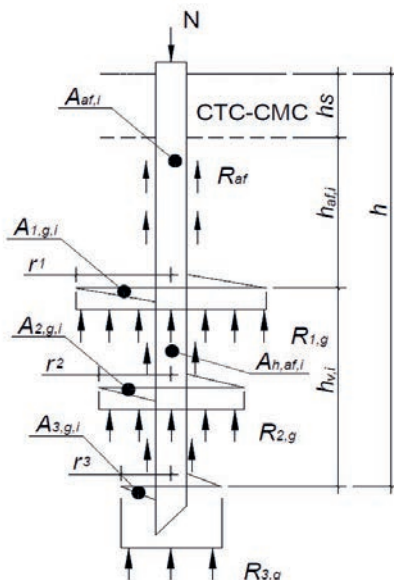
Расчетная схема многолопастной ВС на действие вдавливающей нагрузки
